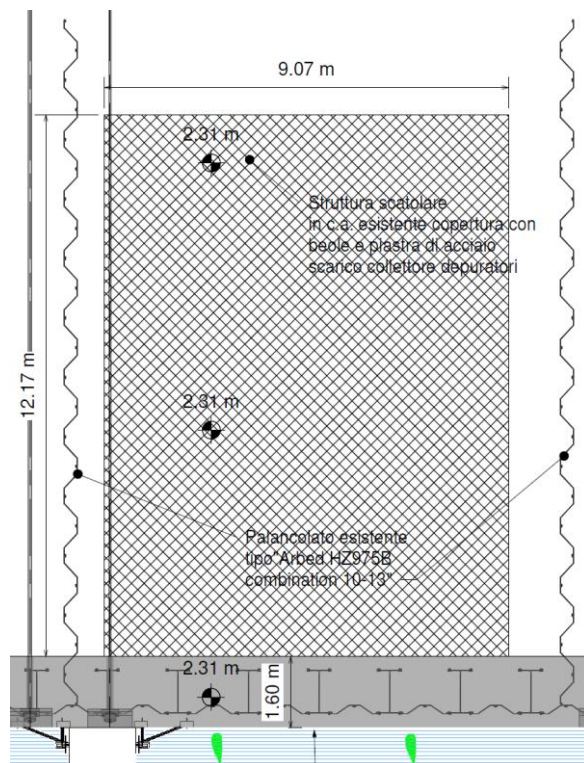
Stralcio planimetrico di rilievo in corrispondenza scarico depuratore
